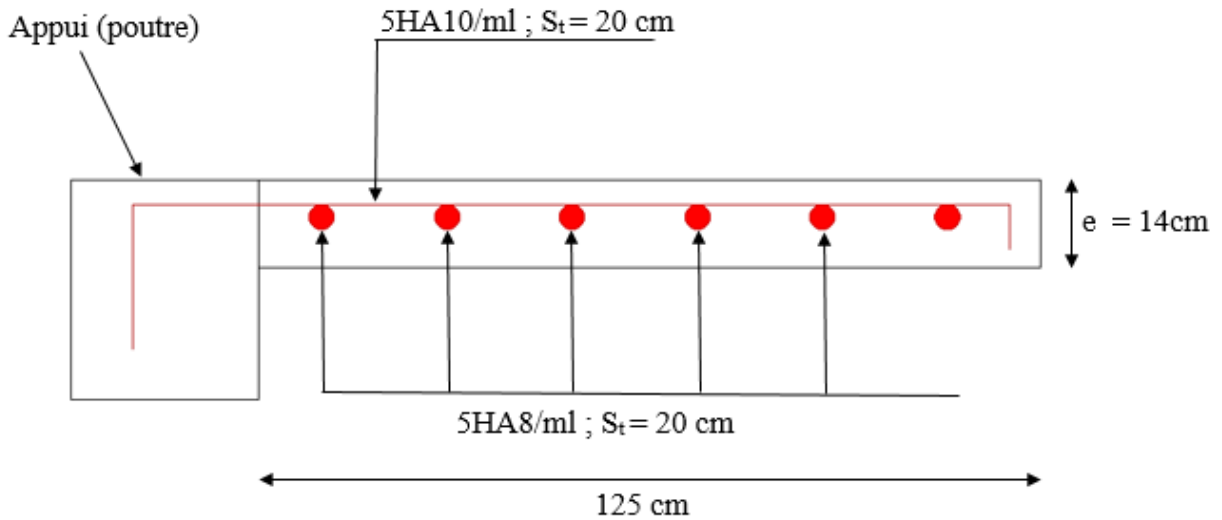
Schéma de ferrailage de la dalle sur un seul appui
